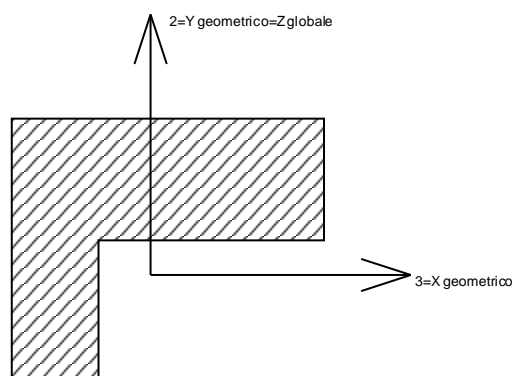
Sistema Locale aste derivanti da travi in c.a.
